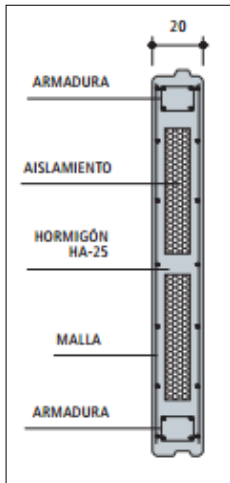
Detall constructiu de panell formigó prefabricat tipus sandvitx.
